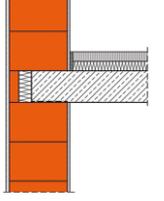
Auszug Ziegel Wärmebrückenatlas 5.0 [2] – Anschlussdetail einbindende Geschossdecke
